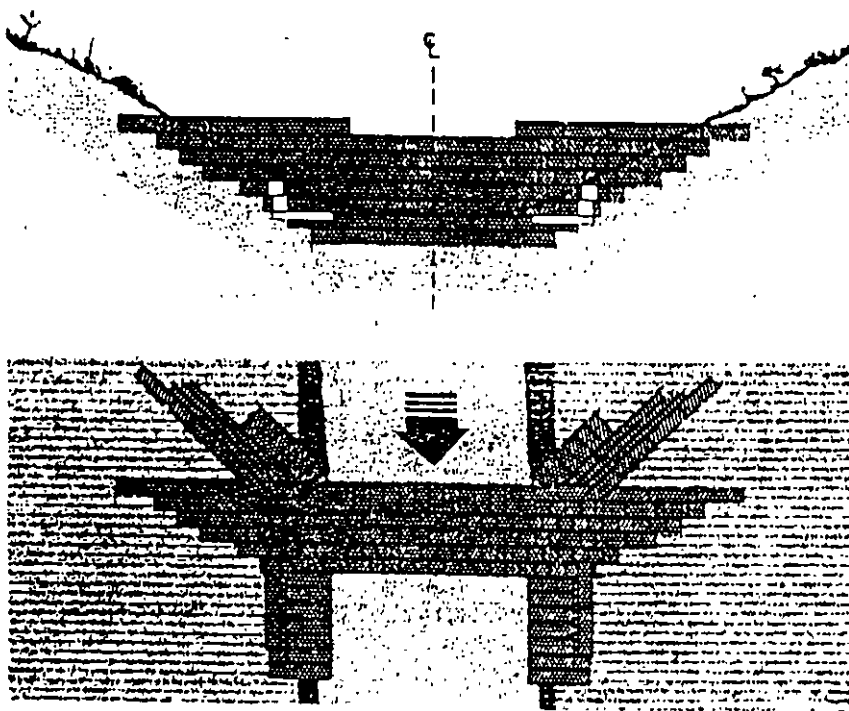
Presa filtrante de gaviones con muros de encauzamiento [6]
